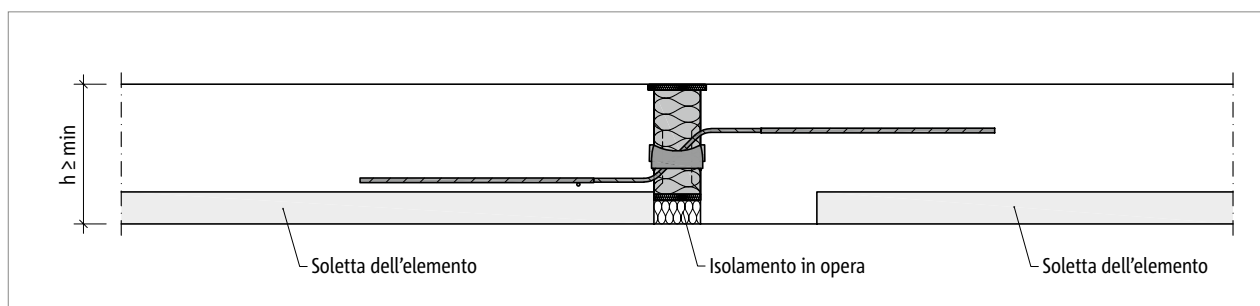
Schöck Isokorb® T tipo QL: solaio prefabbricato con Schöck Isokorb® sovrapposto
